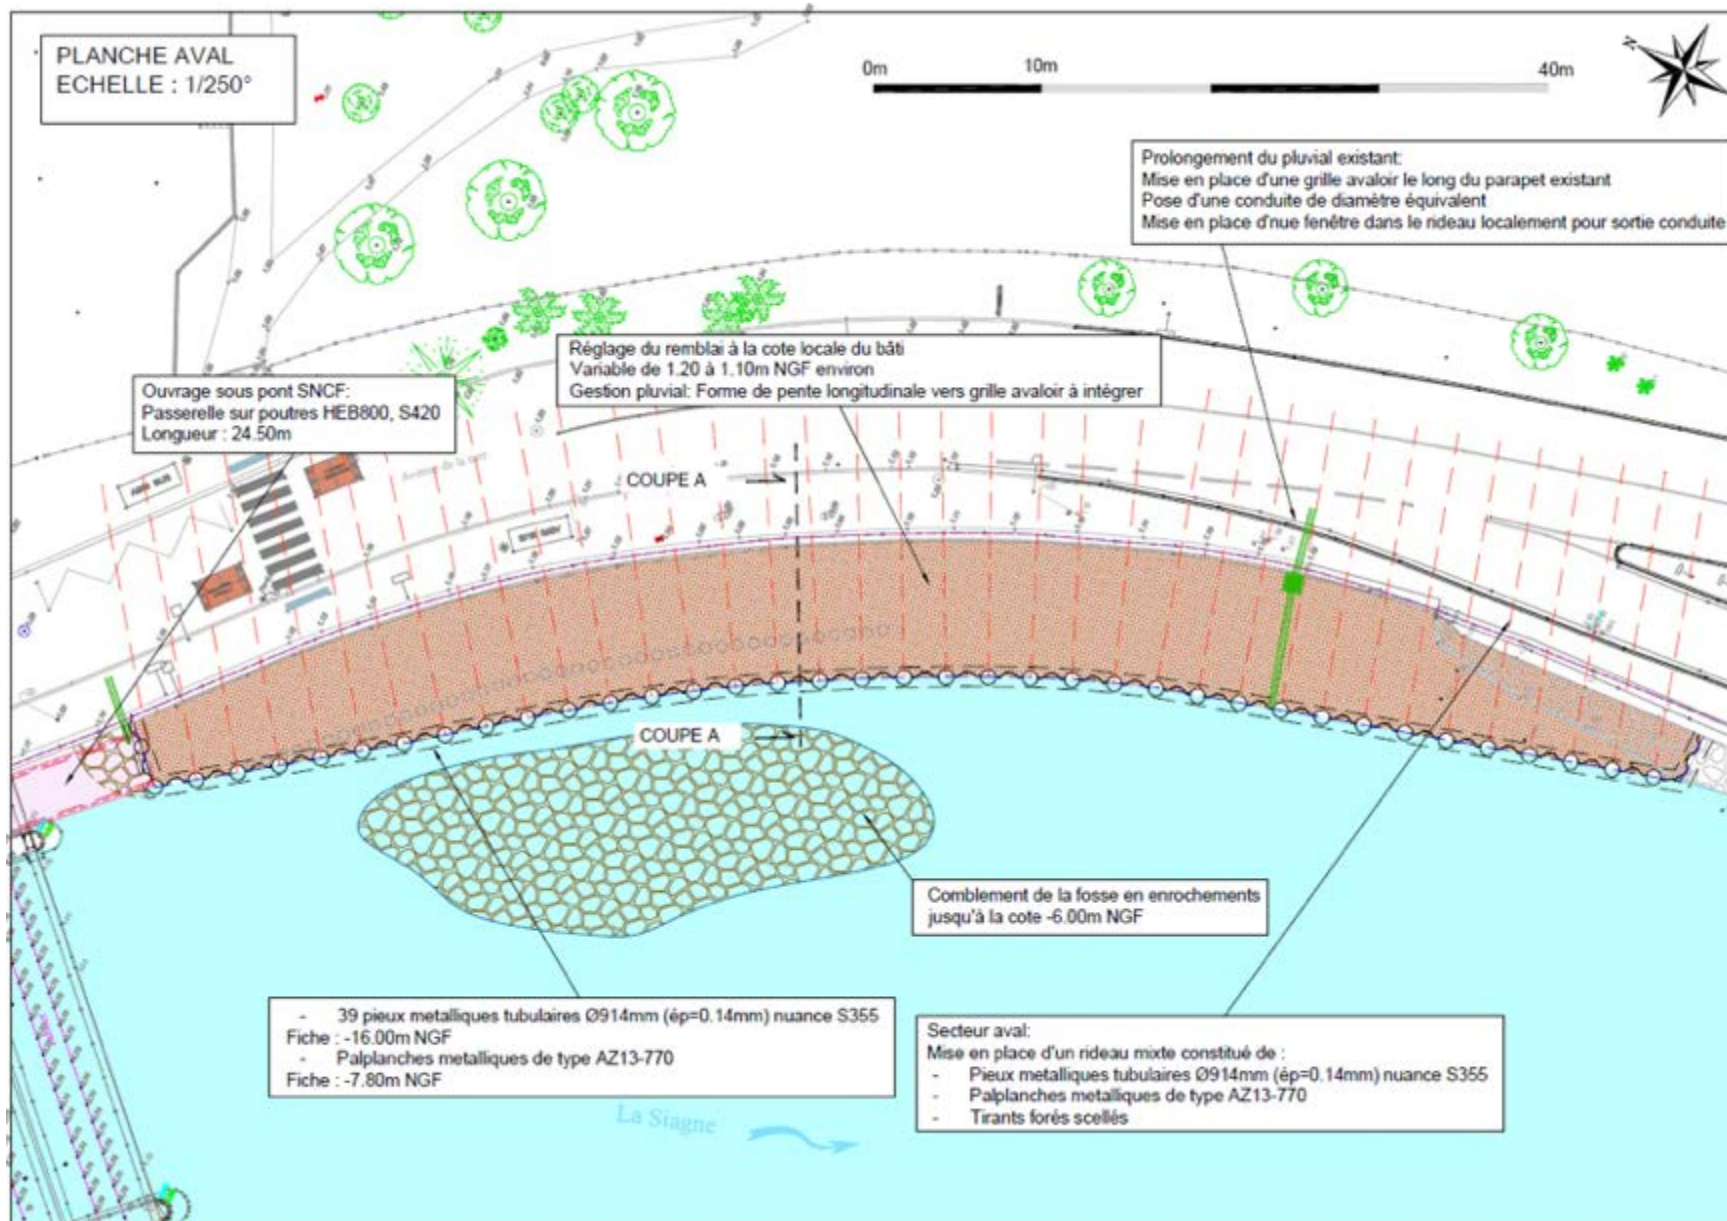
Plan général des travaux projetés - partie aval du Pont SNCF
